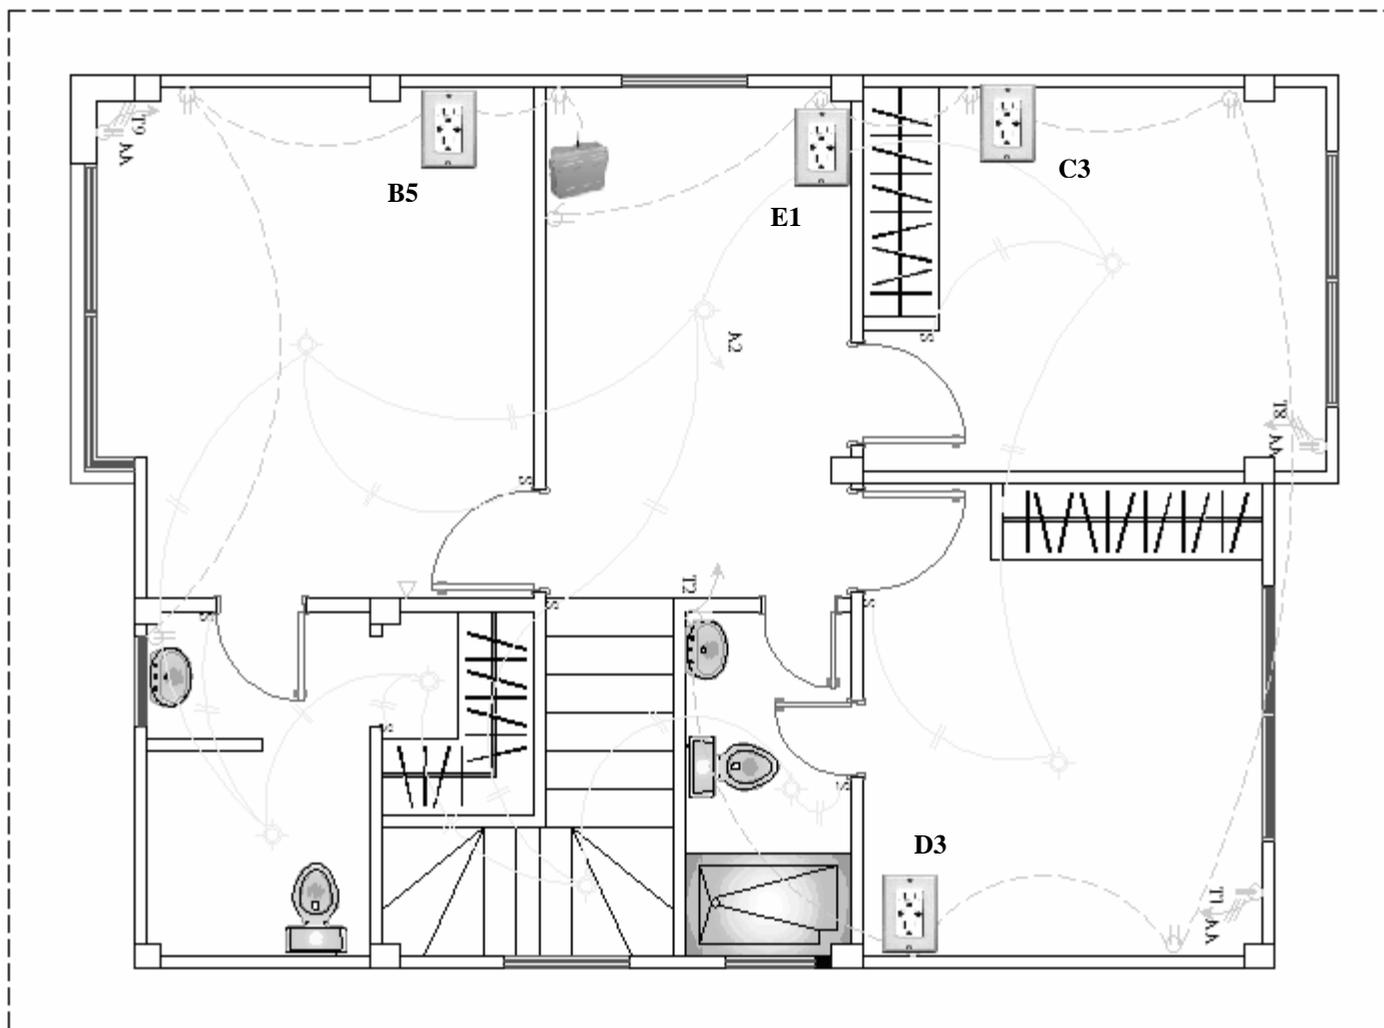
Sistema de Control, Planta Alta, Plano Eléctrico.
